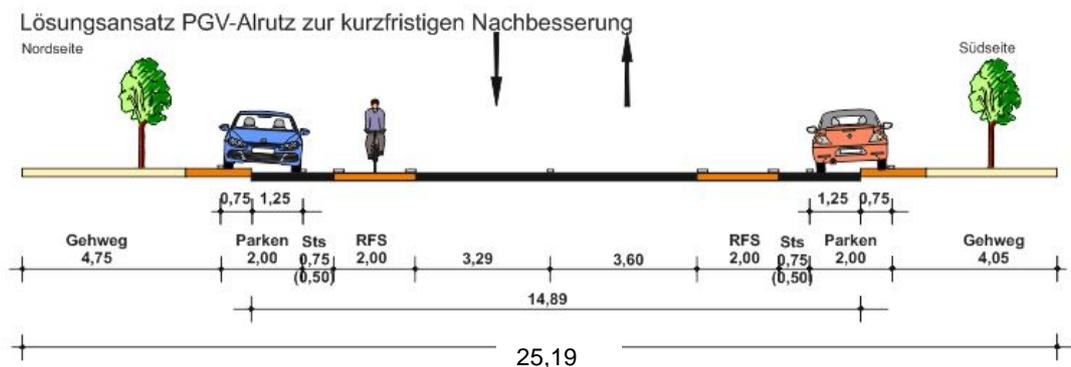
Abschnitt B: empfohlene Nachrüstung mit Sicherheitstrennstreifen, Verlegen des Parkens auf die bisherigen Radwegflächen
